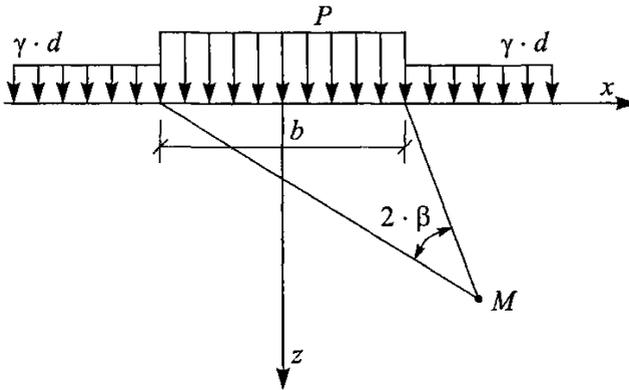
Расчетная схема определения расчетного сопротивления оснований по национальным нормам
